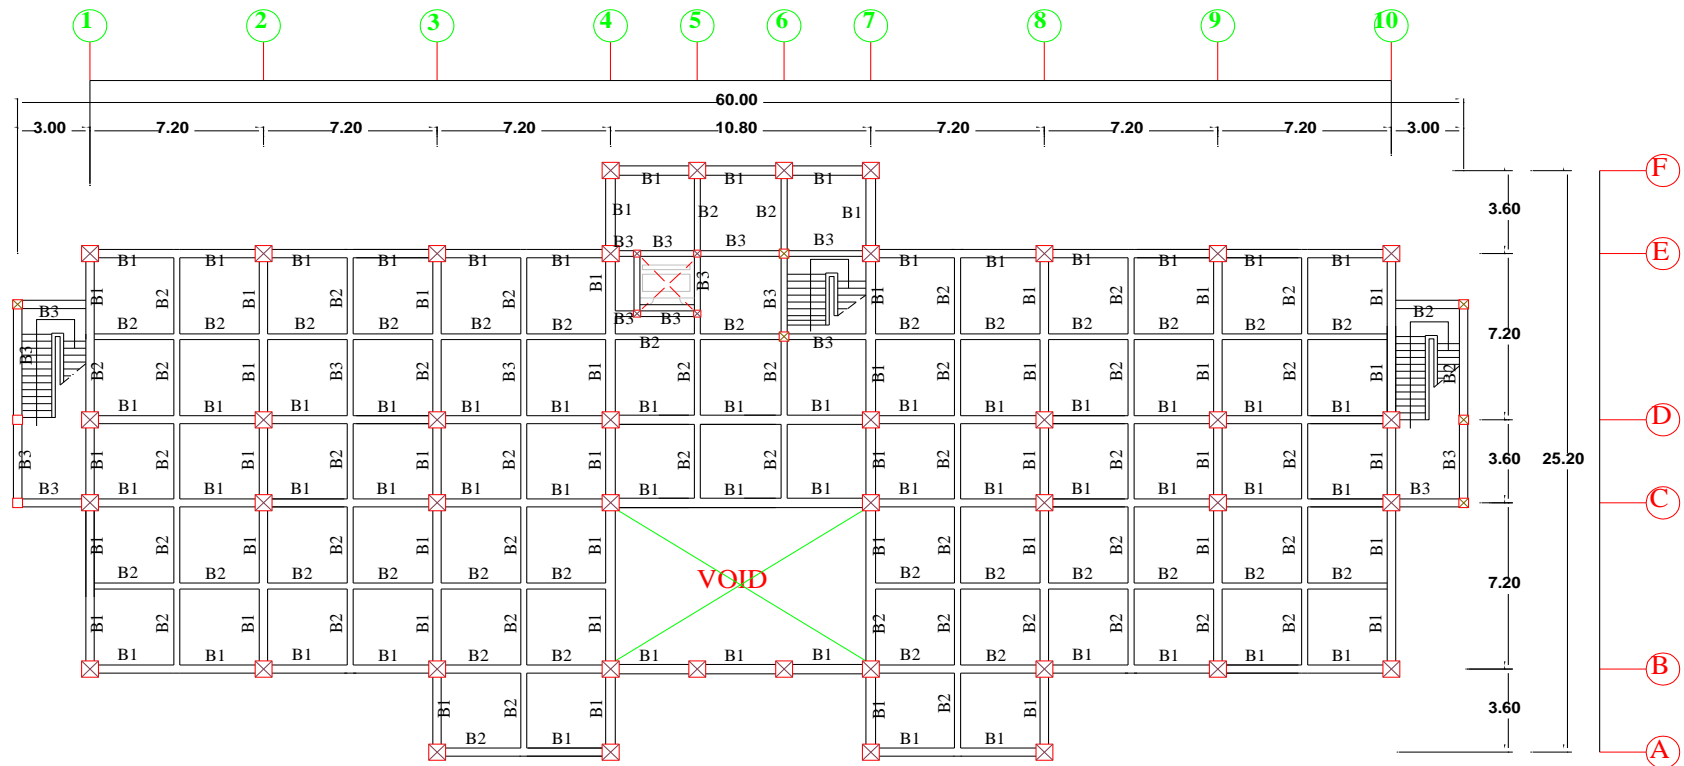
Rencana Kolom Lantai 1-8
